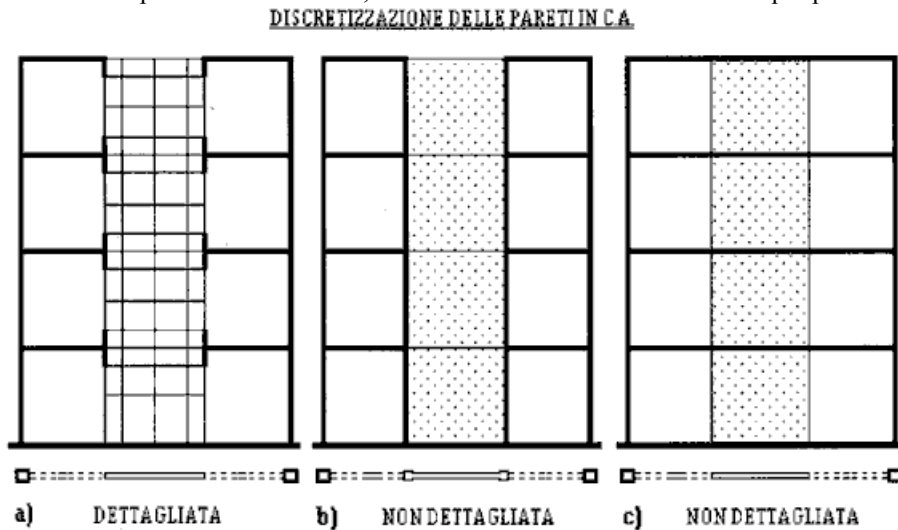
Discretizzazione delle pareti in c.a. modellate con elementi finiti piani
